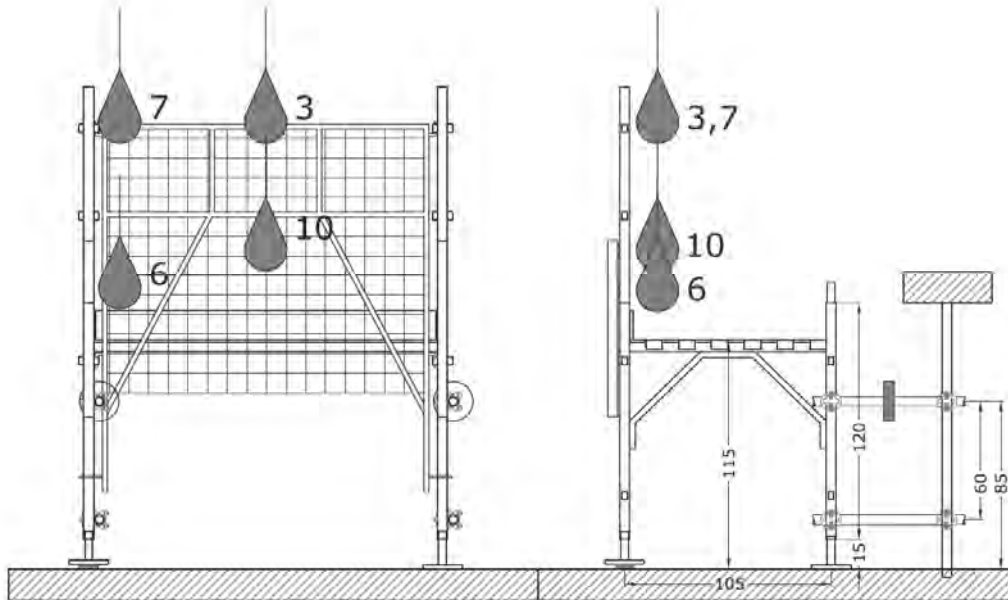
Prova d'impatto con sacco sferoconico su protezione continua (rete) - Schema CSR
